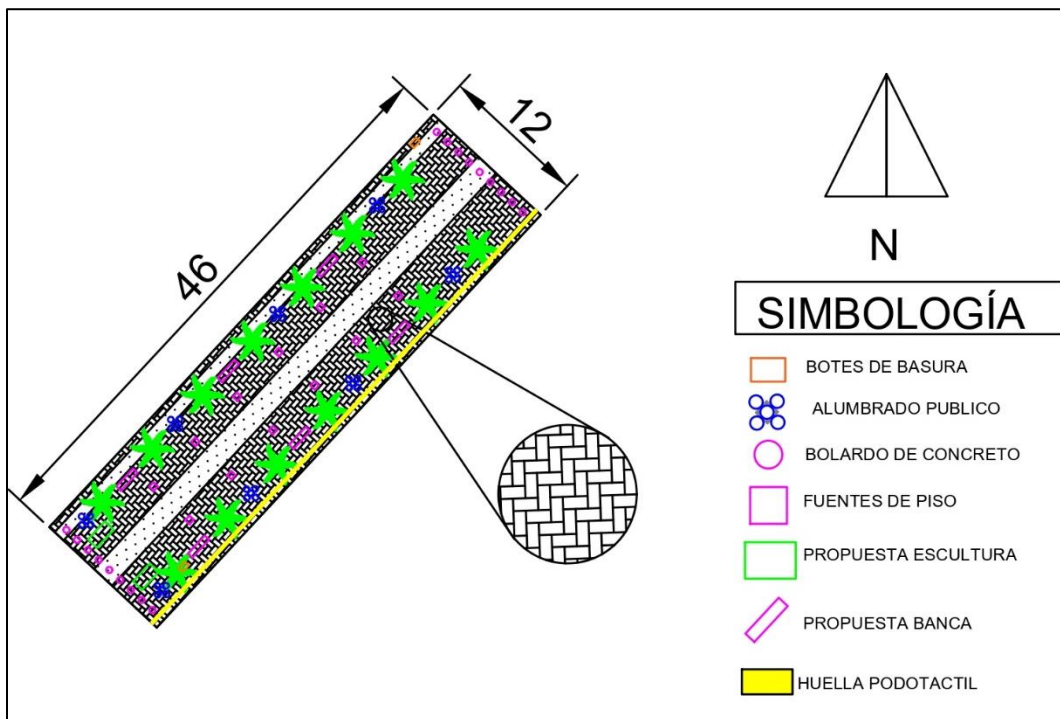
Vista en planta de la propuesta para la calle 1 entre las avenidas 1 y 2.
